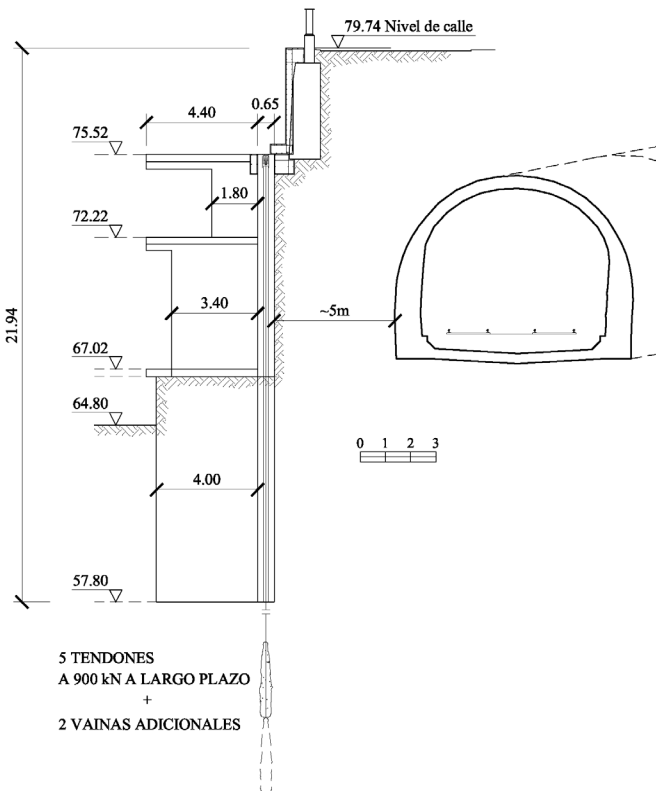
Perfil del muro y sus contrafuertes (perfil del contrafuerte B8).
